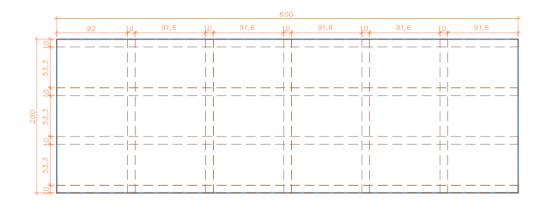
Vista en planta de vigas de madera tipo 1 y 2
